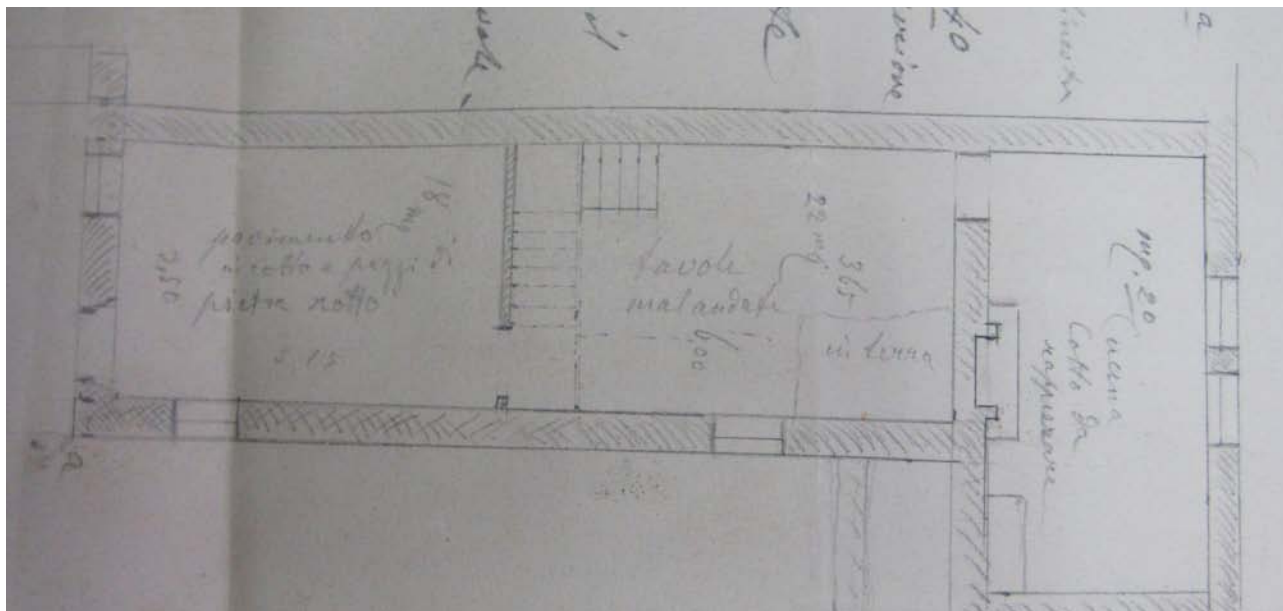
Schizzo della pianta della casetta del sagrestano concessa dalla contessa Elisabetta Rotàri alla chiesa parrocchiale di Avesa. Nel disegno vengono indicati i vari interventi di manutenzione da svolgere per consentirne l'abitazione.⁷⁶
